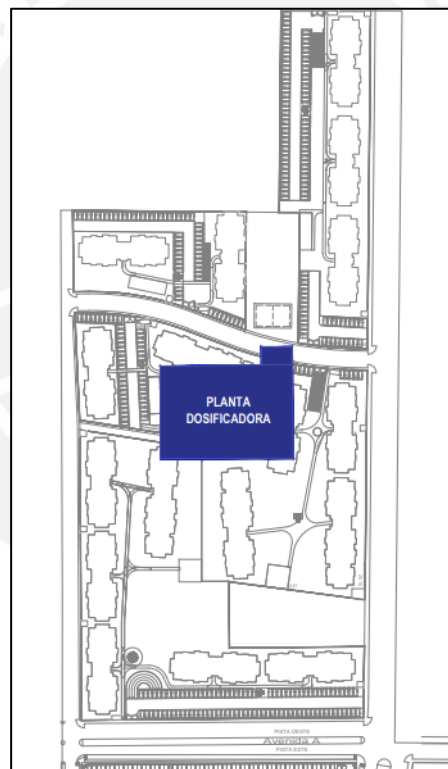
Esquema de ubicación de la planta dosificadora en el proyecto.
